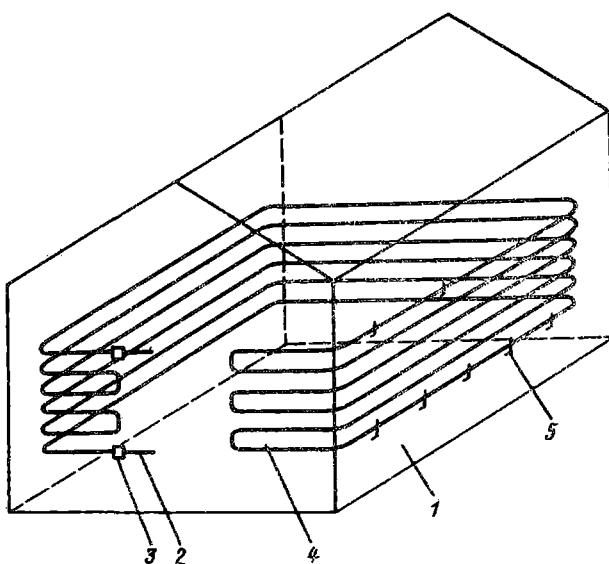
Схема укладки нагревательного провода для обогрева воздуха:
